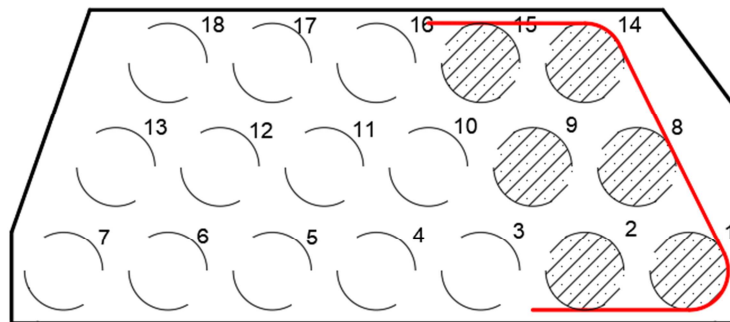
Gruppo di 6 pali di fondazione maggiormente caricati
